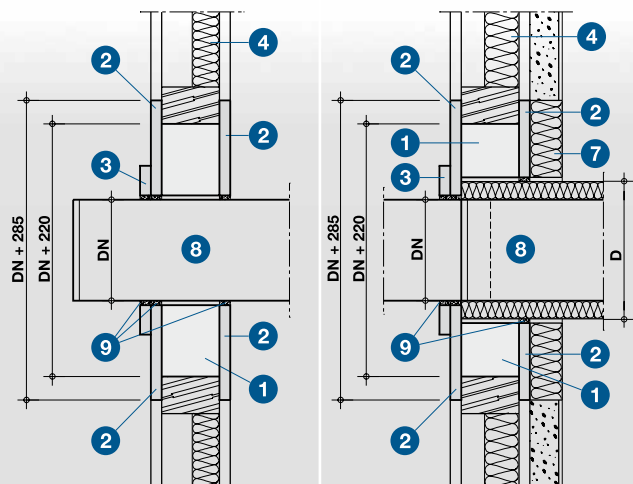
Detail A zeigt den Einbau der Promat®-Rauchrohrdurchführung (1) in Holzständerwände (Innenwände). Die Abdeckplatte (2) ist einseitig an der Rauchrohrdurchführung befestigt, die gegenüberliegende Abdeckplatte liegt lose bei und ist nach dem Einbau zu verschrauben oder zu klammern. Der Anschlussring (3) kann optional ein- oder beidseitig angebracht werden. Er dient als Abstandshalter zwischen Rauchrohr und Putz bzw. Tapete. Der Anschlussring (3) kann durch die Stahlrose des Schornsteinherstellers abgedeckt werden.
